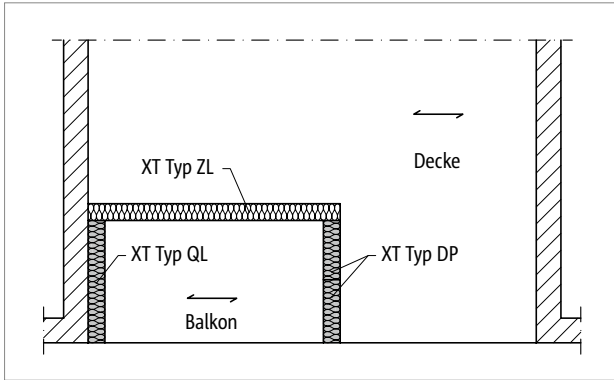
Schöck Isokorb® XT Typ DP, QL: Decke einachsig gespannt
